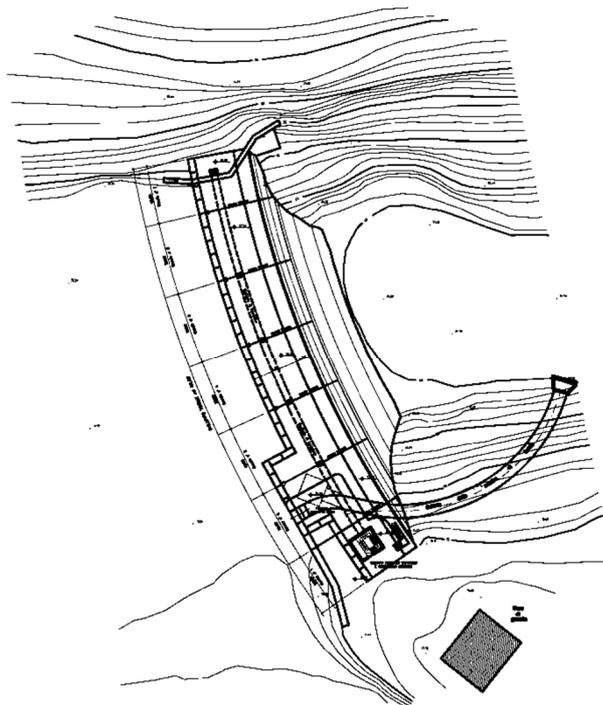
Schema degli interventi in progetto – Planimetria
